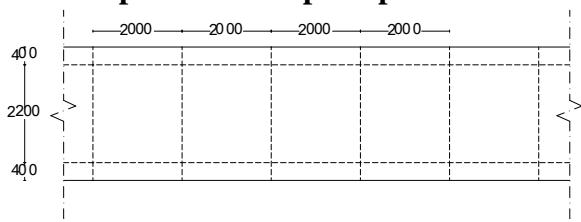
Denah dan potongan pada pelat dan balok jalan beton
